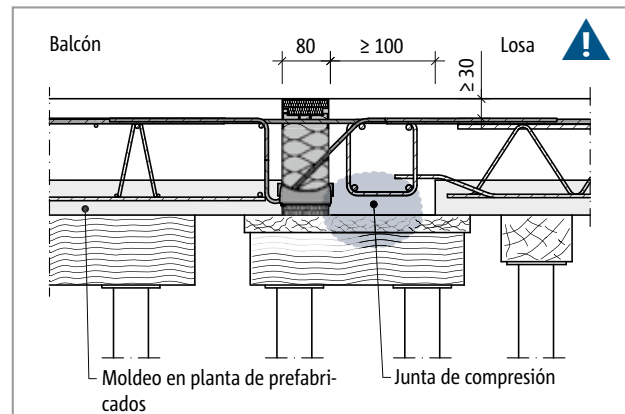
Schöck Isokorb® T tipo K/K-F: apoyo indirecto, instalación conjunta con placas prefabricadas (aquí:  $h \leq 170$  mm), junta de compresión del lado de la losa
